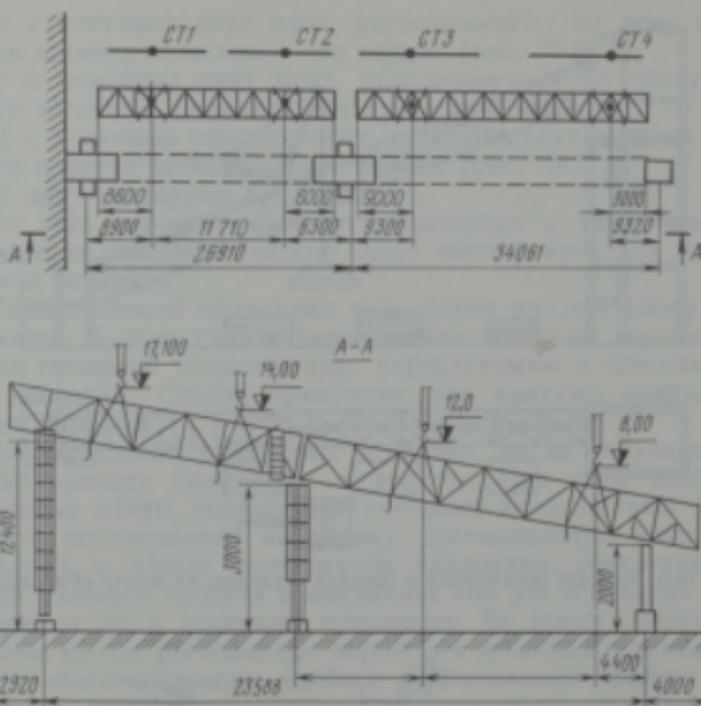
Монтаж пролетного строения двумя кранами (СТ1—4 — стойки кранов)
